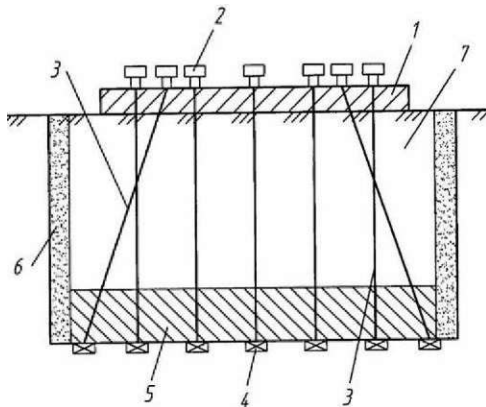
Конструктивно-технологічна схема переднапруженого фундаменту: 1 – плита; 2 – домкрат; 3 – анкерна тяга; 4 – анкер; 5 – опорна плита; 6 – стіна в ґрунті або шпунтова стінка; 7 – ґрунтова основа
